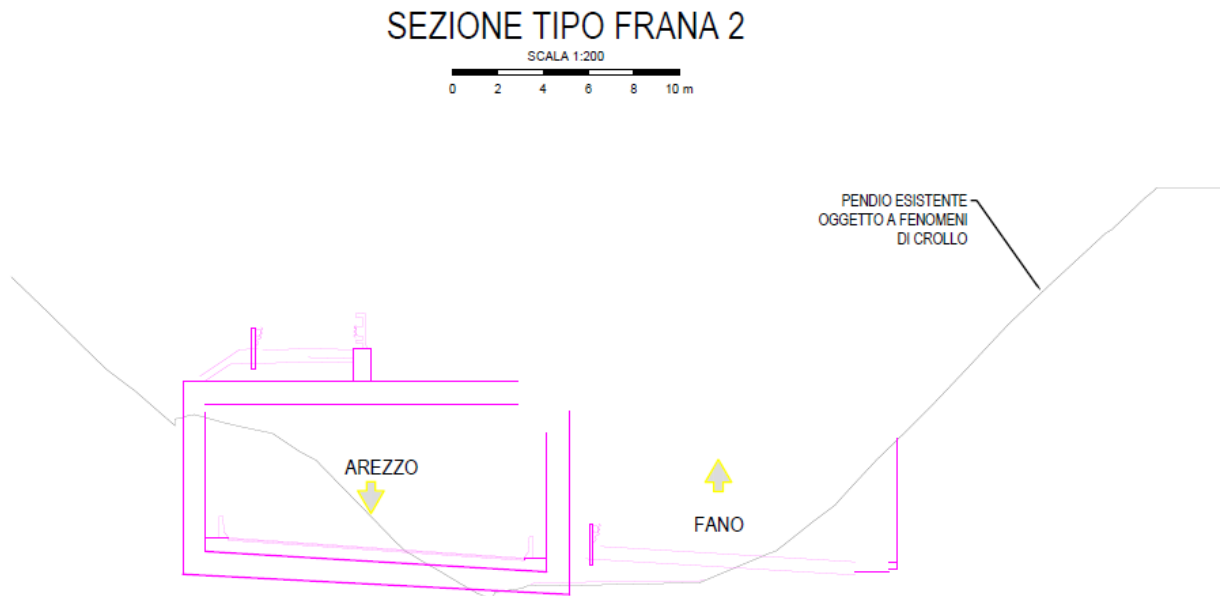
Schema tipo della sezione topografica con indicazione delle opere in progetto
